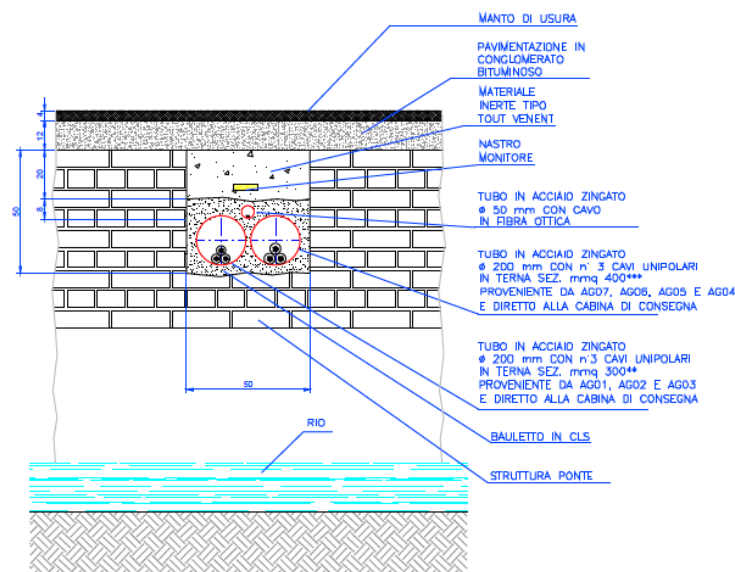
sezione tipologica di attraversamento a profondità ridotta
